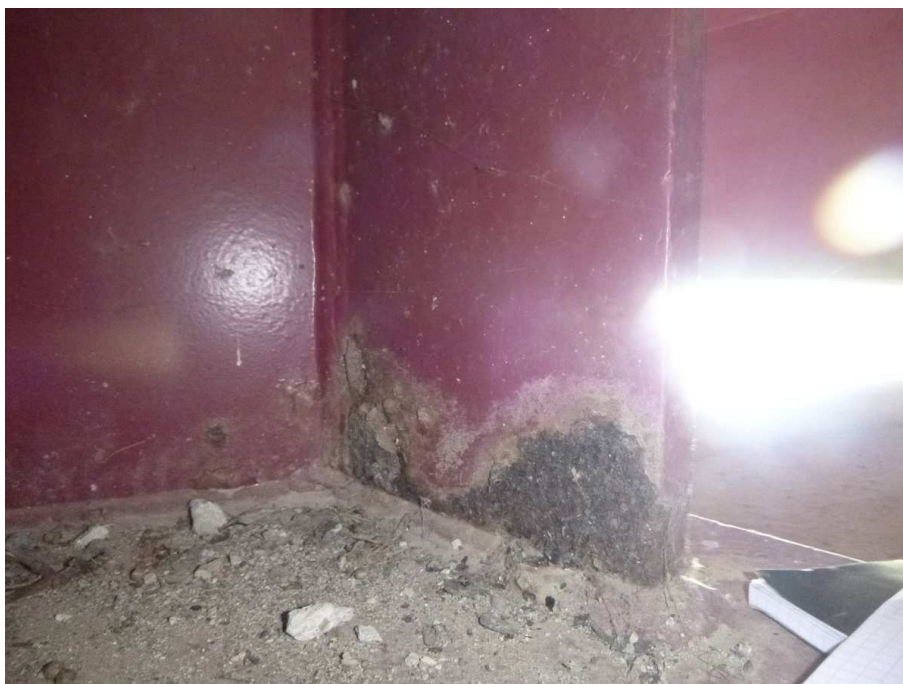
Ecaillage de peinture sur l'âme de la poutre Po2 face amont
